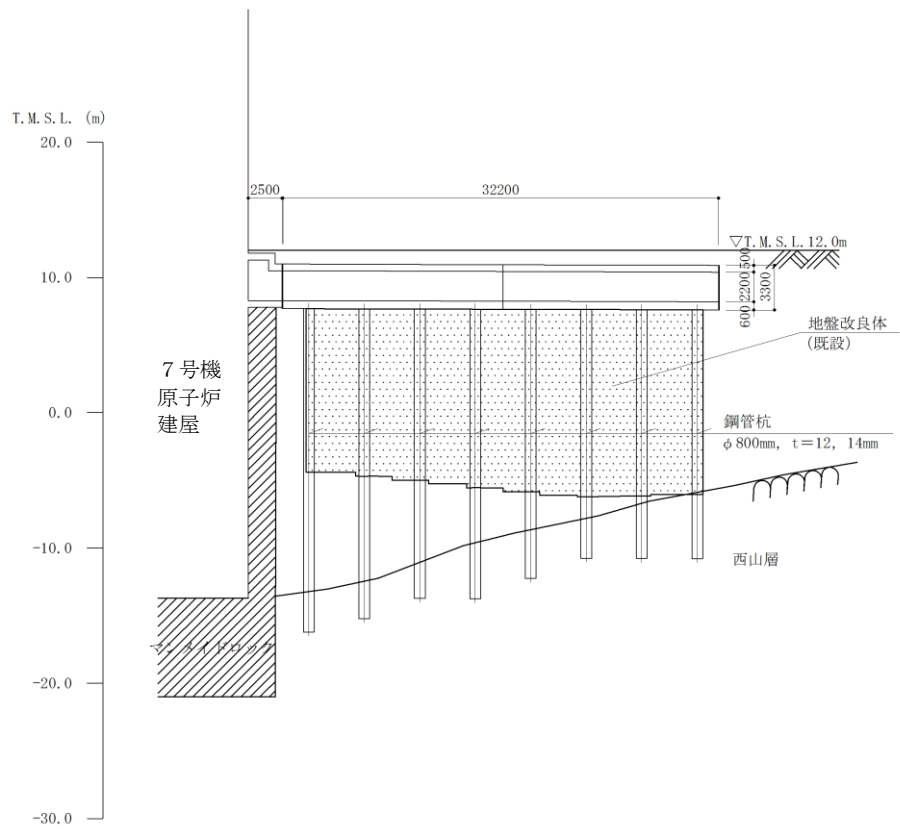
燃料移送系配管ダクト断面図 (A-A 断面)
